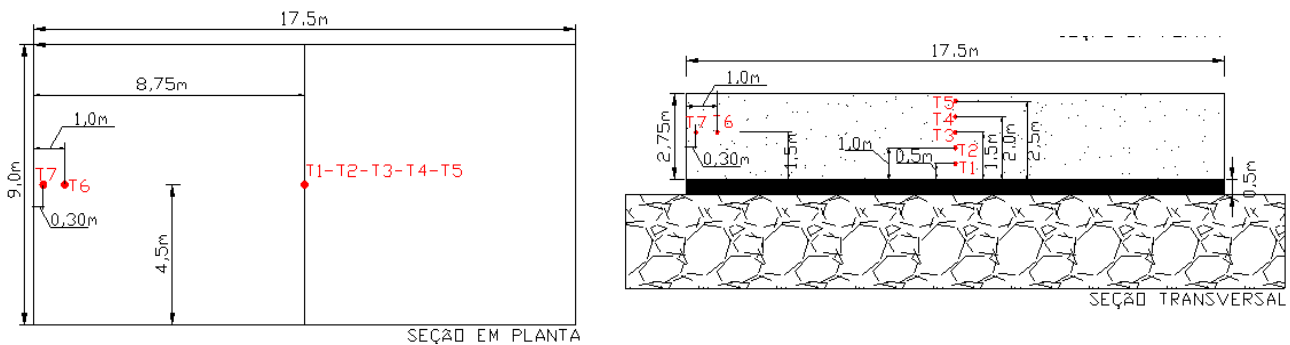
Seção em Planta e Transversal do bloco – Notar localização dos pontos de estudo
